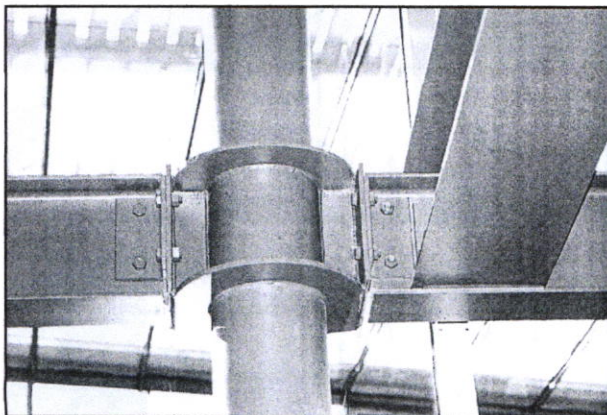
jonction poteau-poteau ; source : auteurs 2018.
